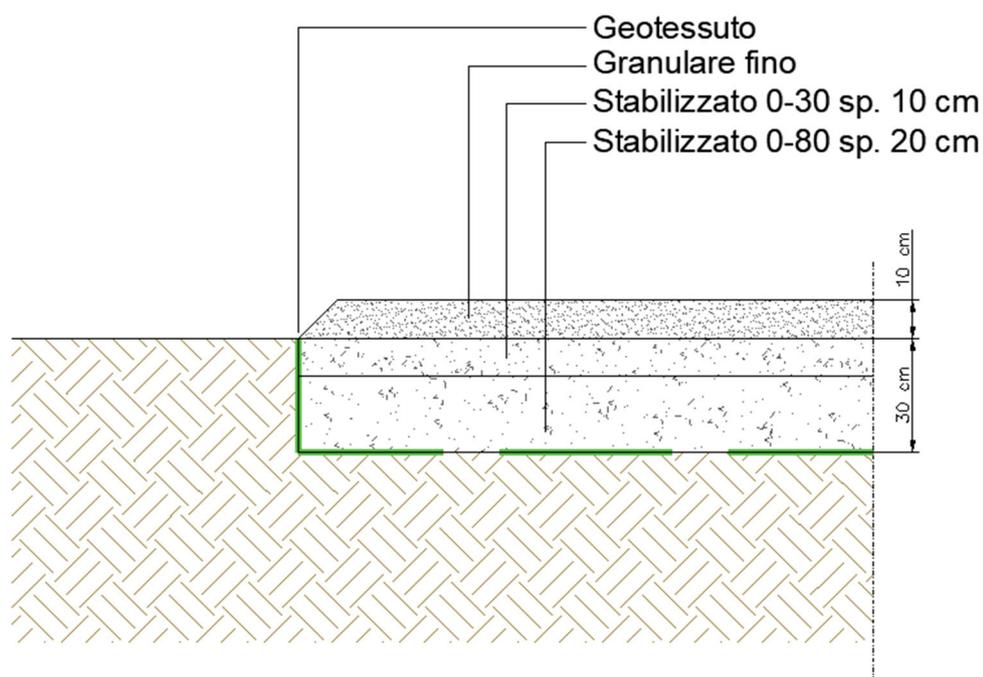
Sezione tipo viabilità interna all'impianto e piazzali
